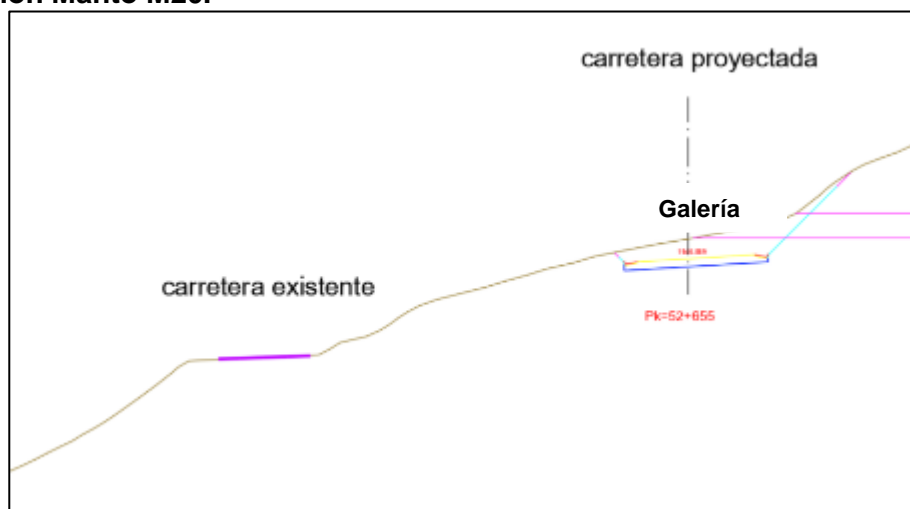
Sección Transversal en PK 52+760. En color púrpura la cota de galería indicada en Plano Explotación Manto M20.
